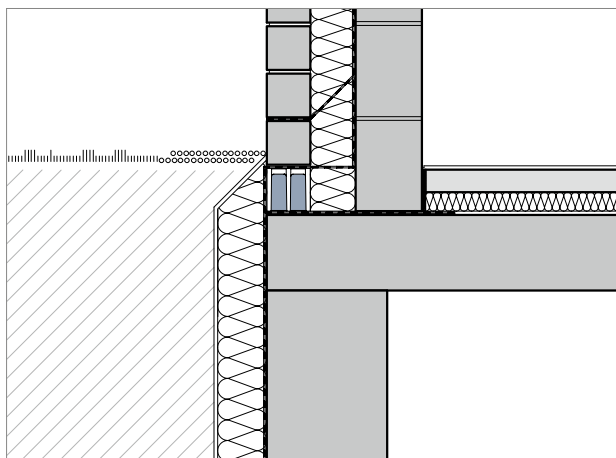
Schöck Sconnex® typ M u obvodové stěny na základové konstrukci
